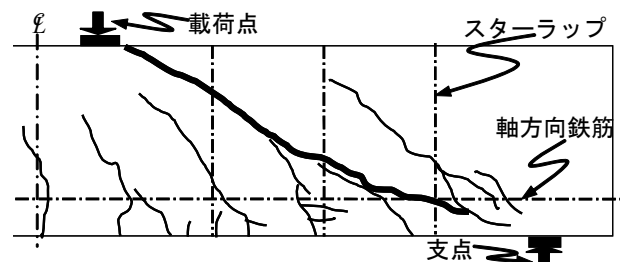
RSF はりのひび割れ図 (SF10-r24)⁴⁾
